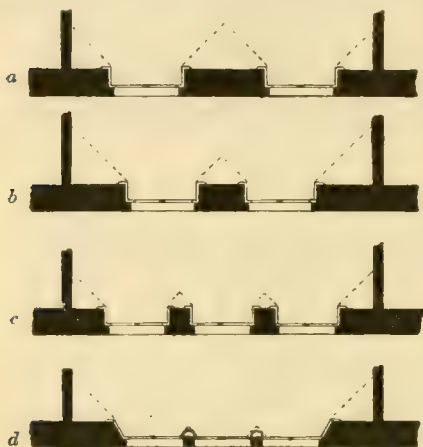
Grundriss verschiedener Fenstergestaltungen.
